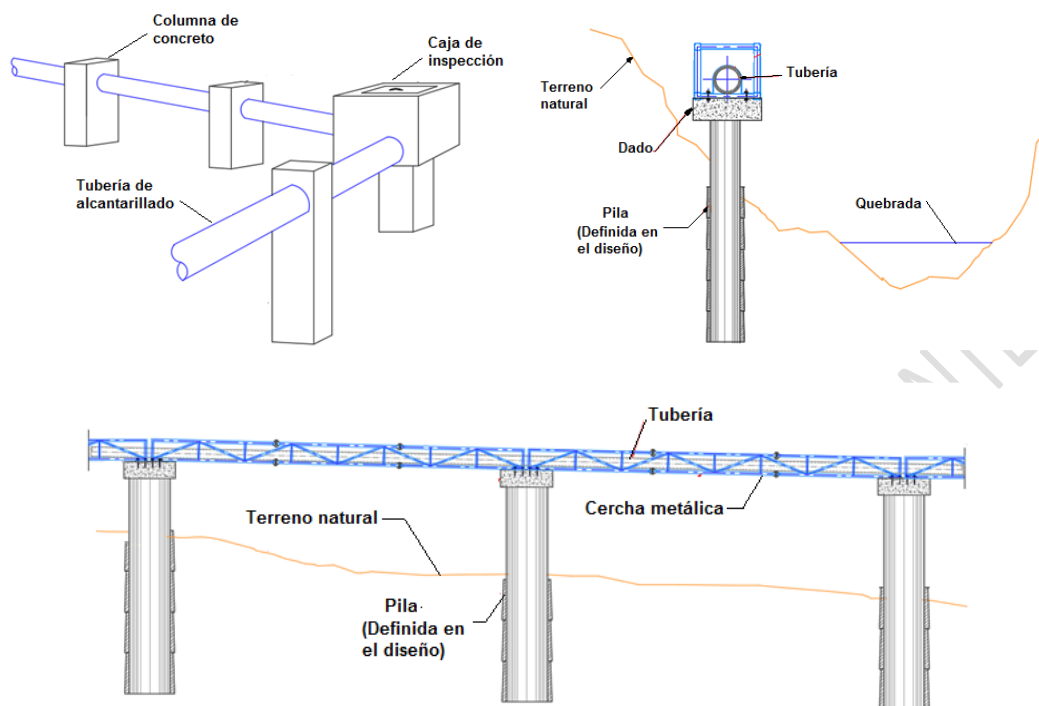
Columnas, pilas y cerchas para apoyo de tuberías de alcantarillado
